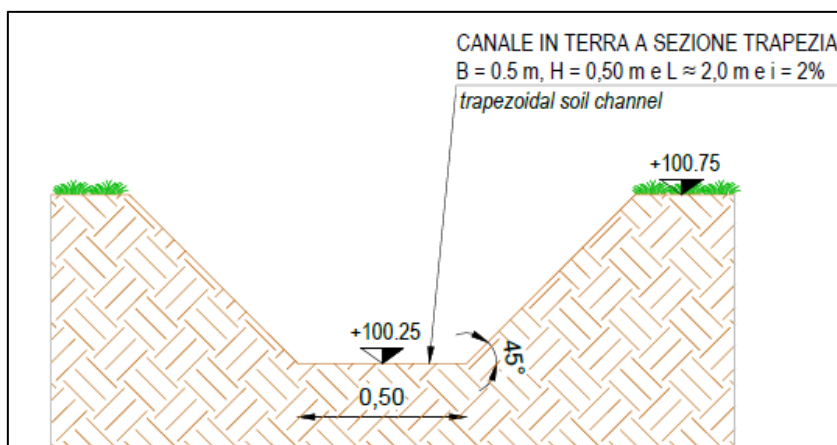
sezione di imbocco canale di sfioro – Parcheggio P2
